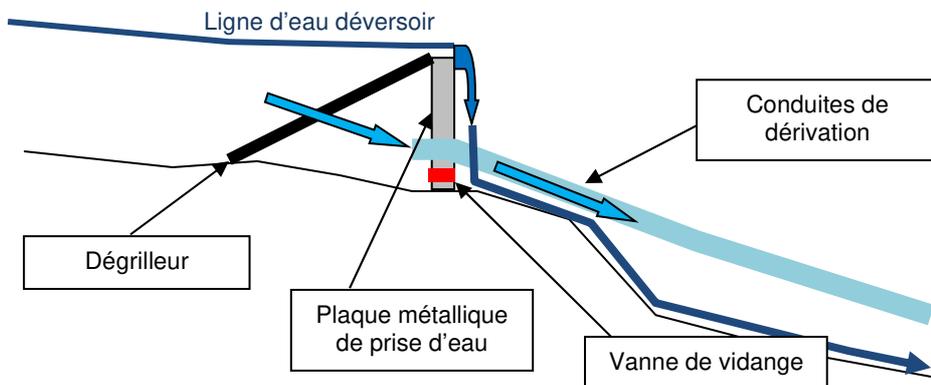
Schéma de principe en coupe de la prise d'eau projeté
